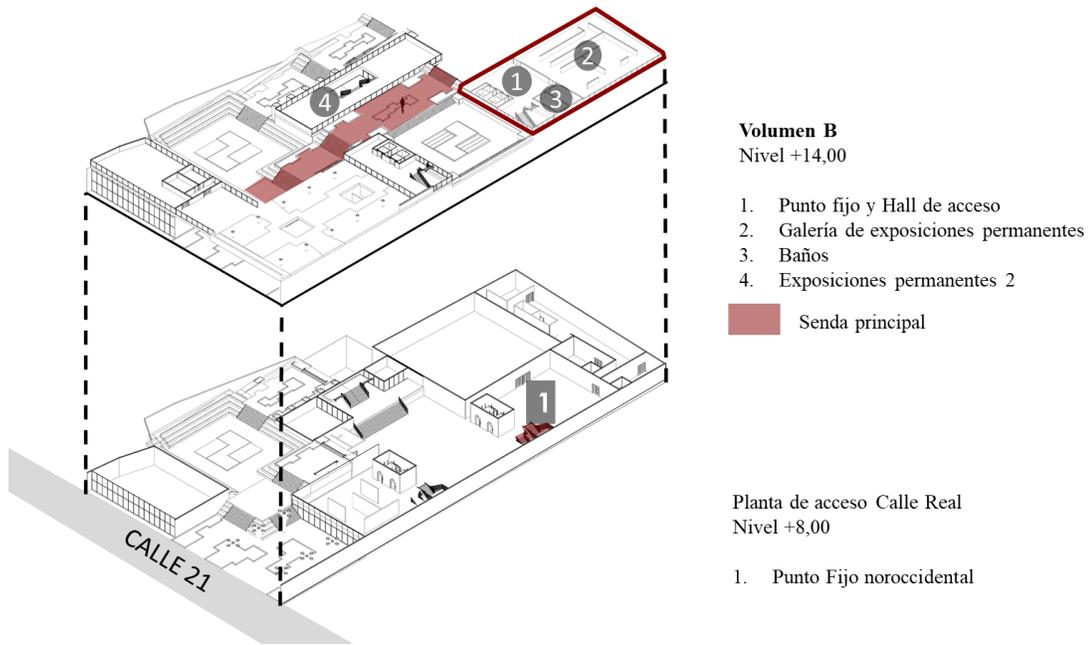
Planta de acceso al teatro y galerías de volúmenes B y C
